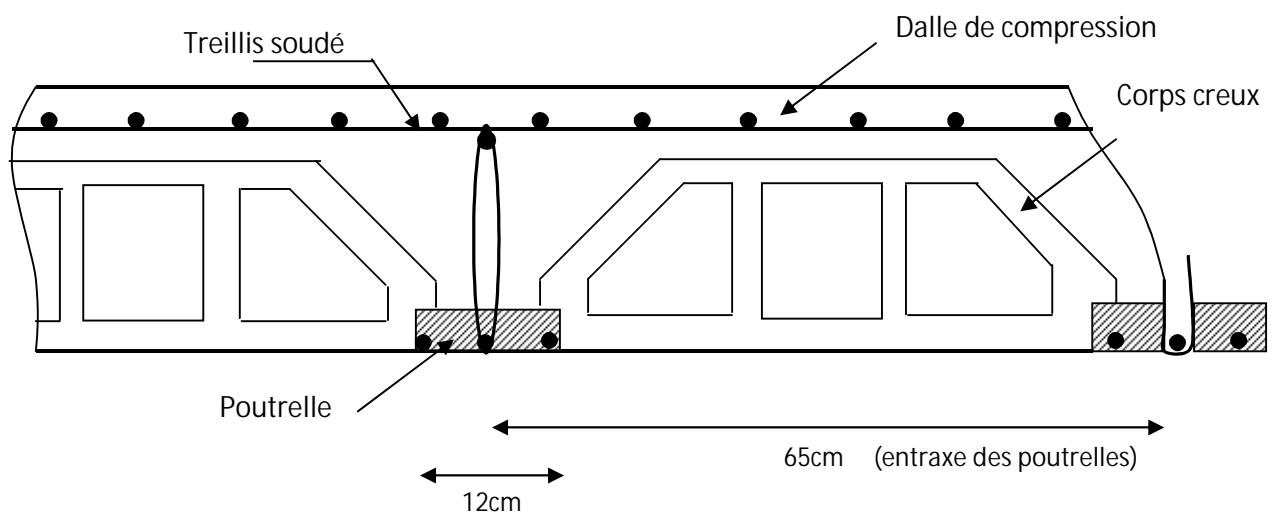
Coupe transversale d'un plancher à corps creux.
